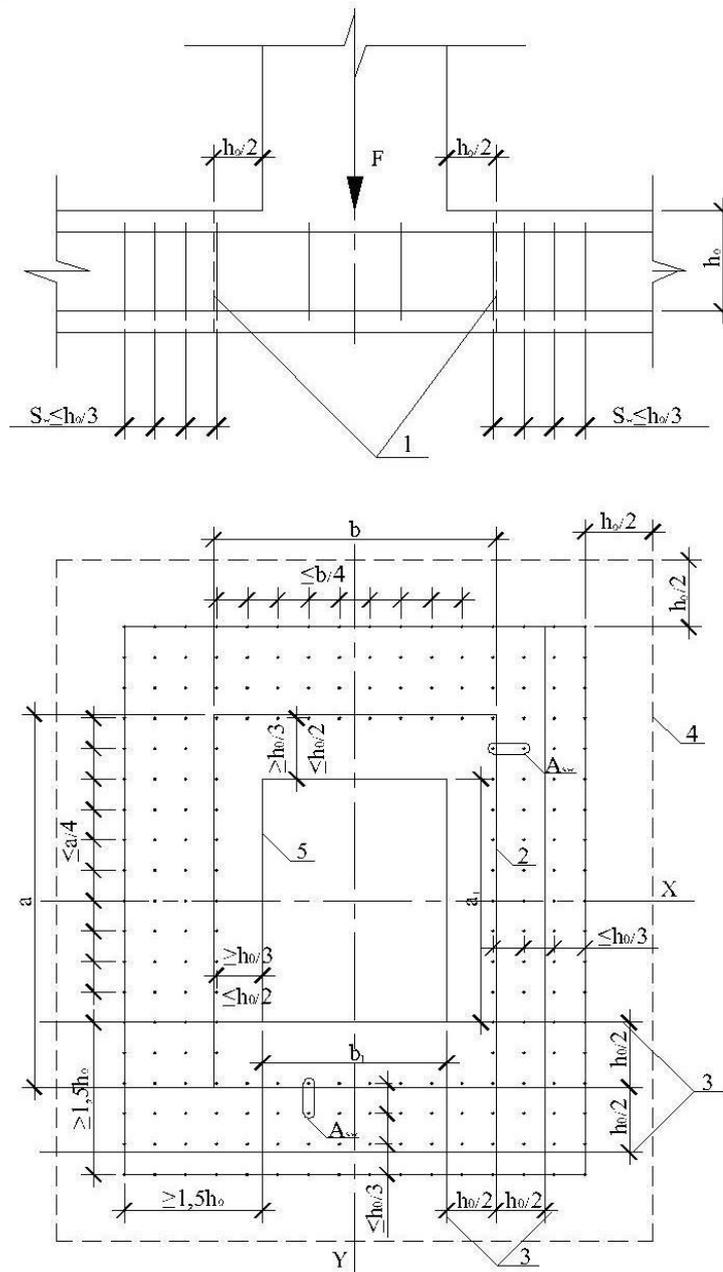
Схема для расчета железобетонной плиты перекрытия на продавливание
